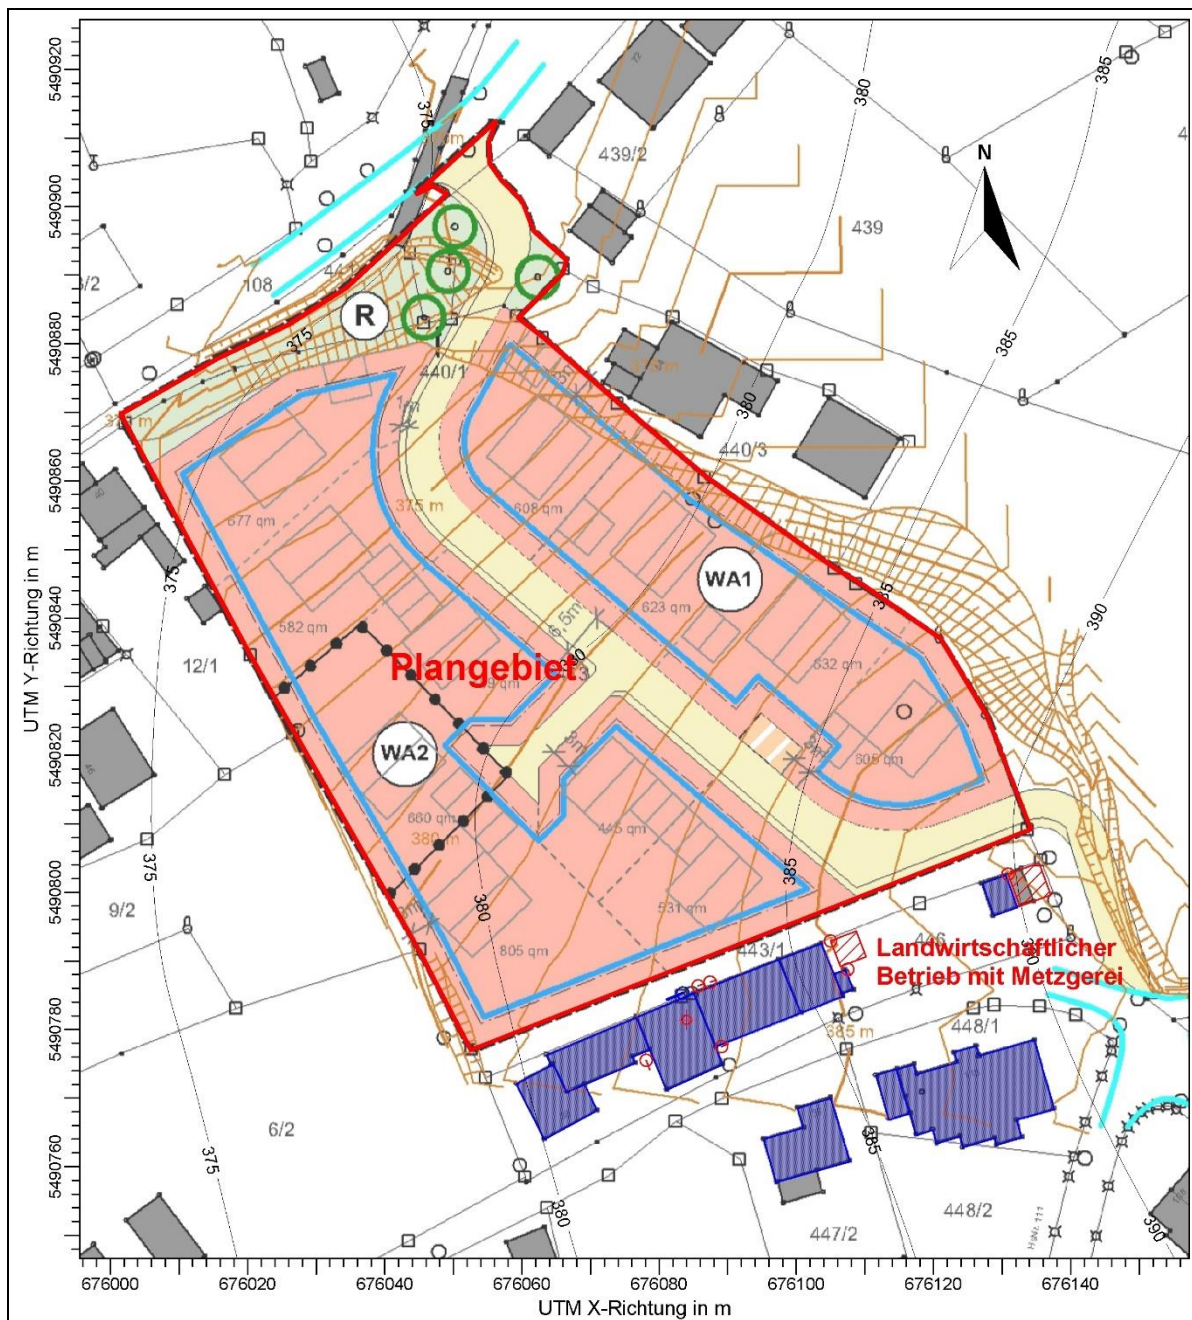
Lageplan Plangebiet und landwirtschaftlicher Betrieb
